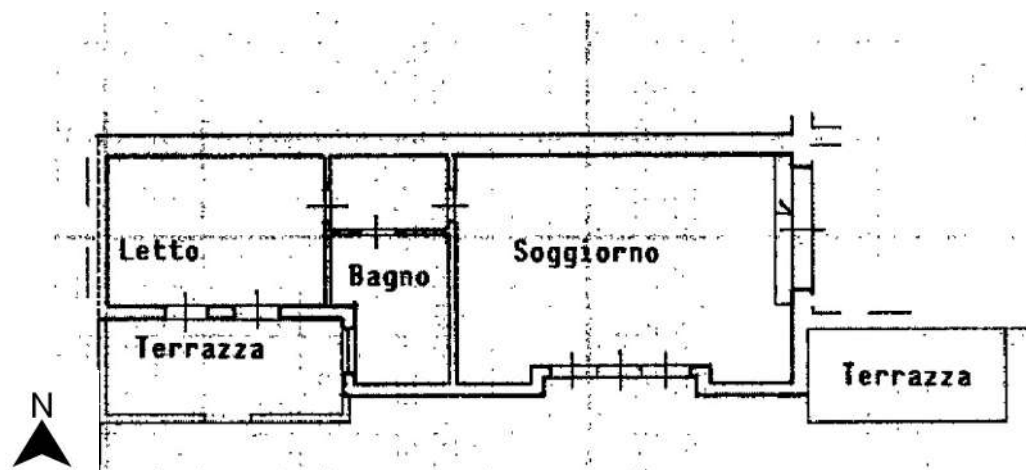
Planimetria catastale P.lla 953 sub. 1 abitazione – stato approvato
